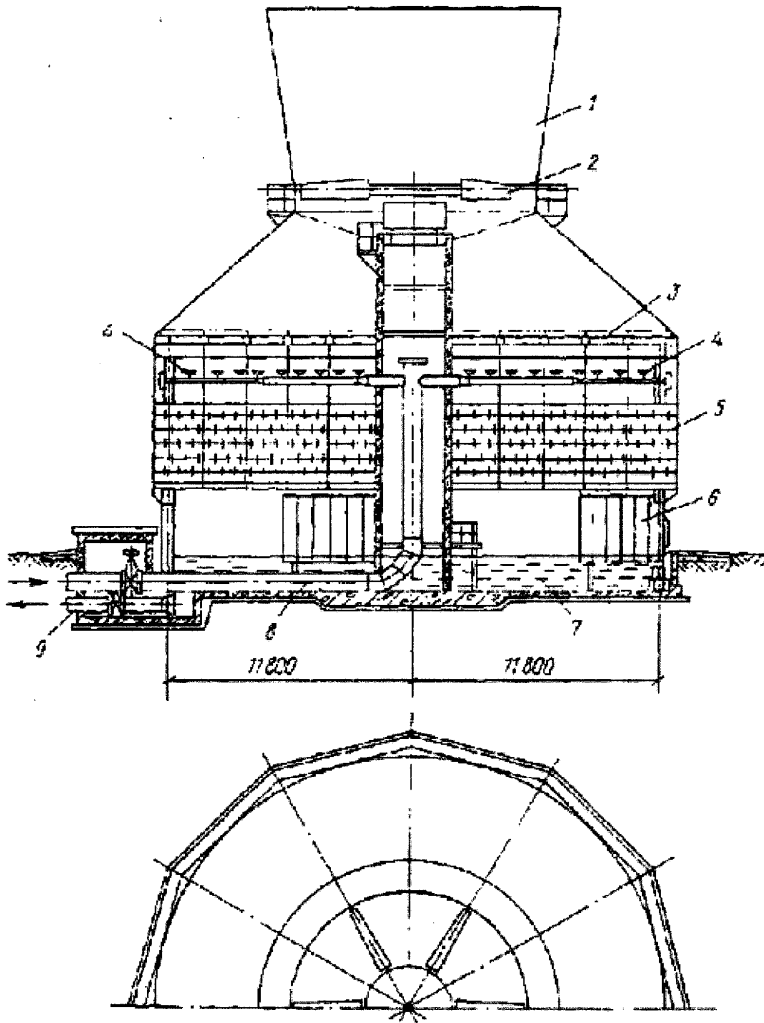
Схема дванадцятигранної одно вентиляторної градирні площею 400 м^2 з вентилятором 1ВГ 104
